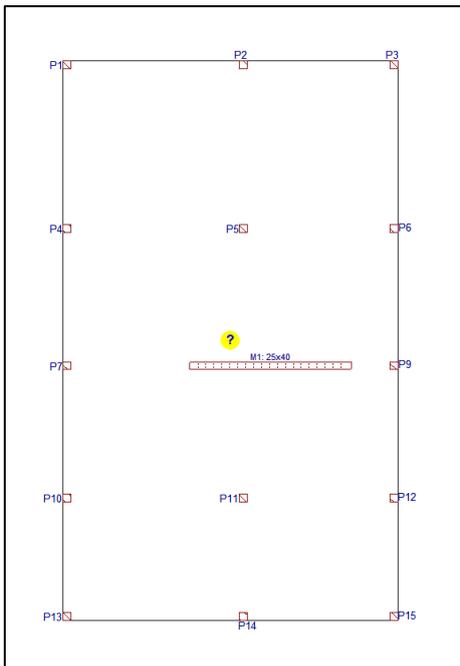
Recorte de pantalla, Planta de cimentación de Cypecad
